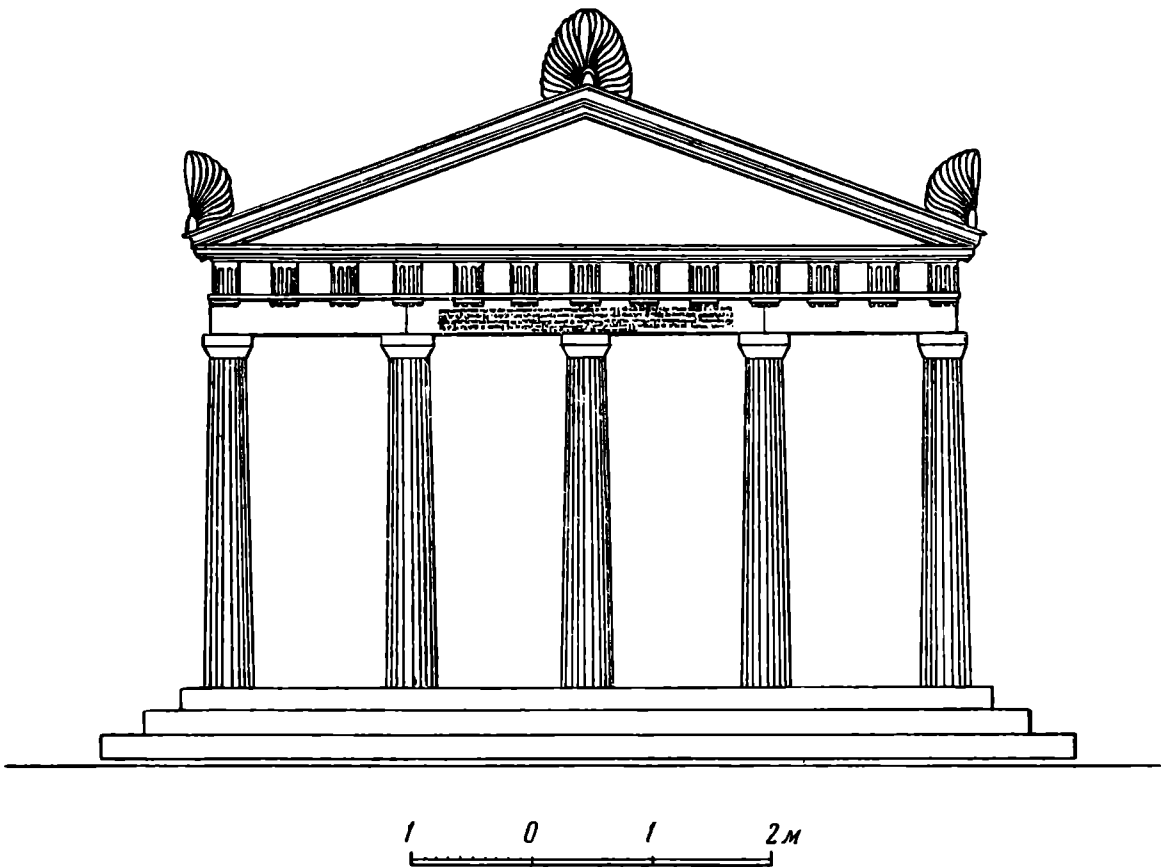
Реконструкция фасада здания, посвященного Аспургу
